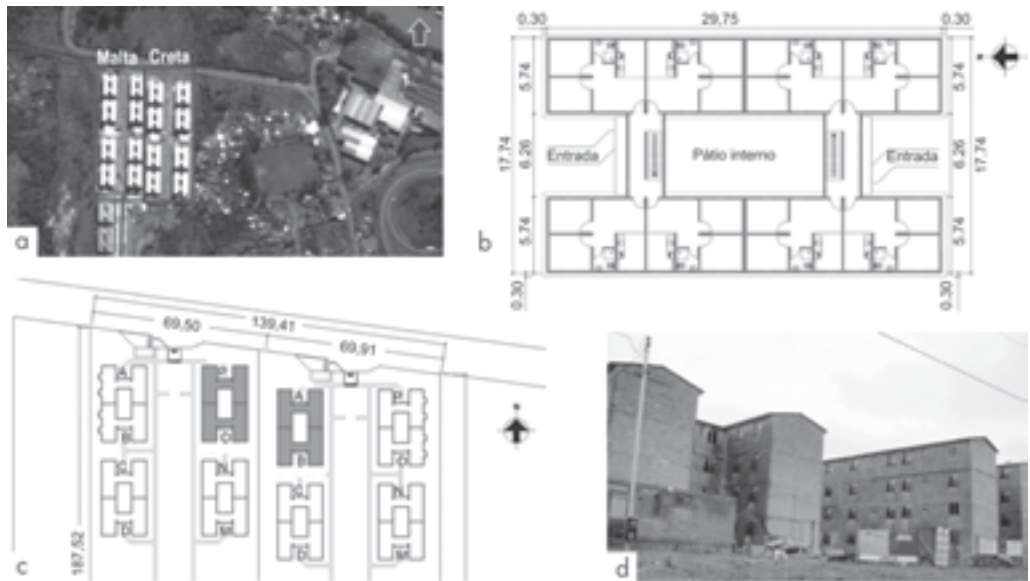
Disposição das edificações em alvenaria de blocos de concreto e cerâmico.
